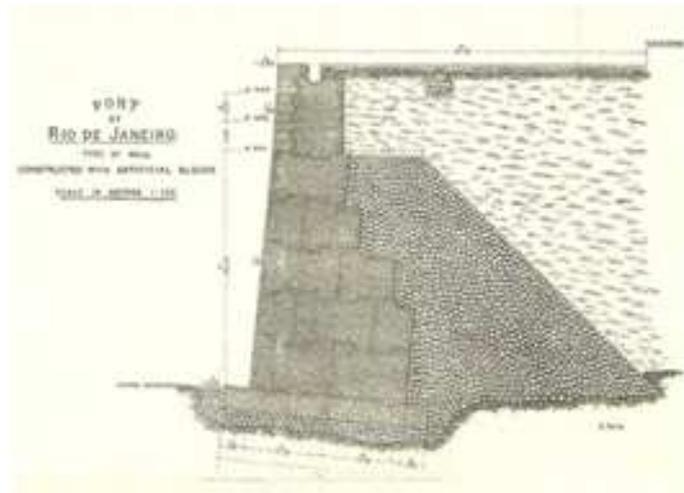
Cópia do desenho original do corte esquemático da muralha do projeto de 1902-1903.
